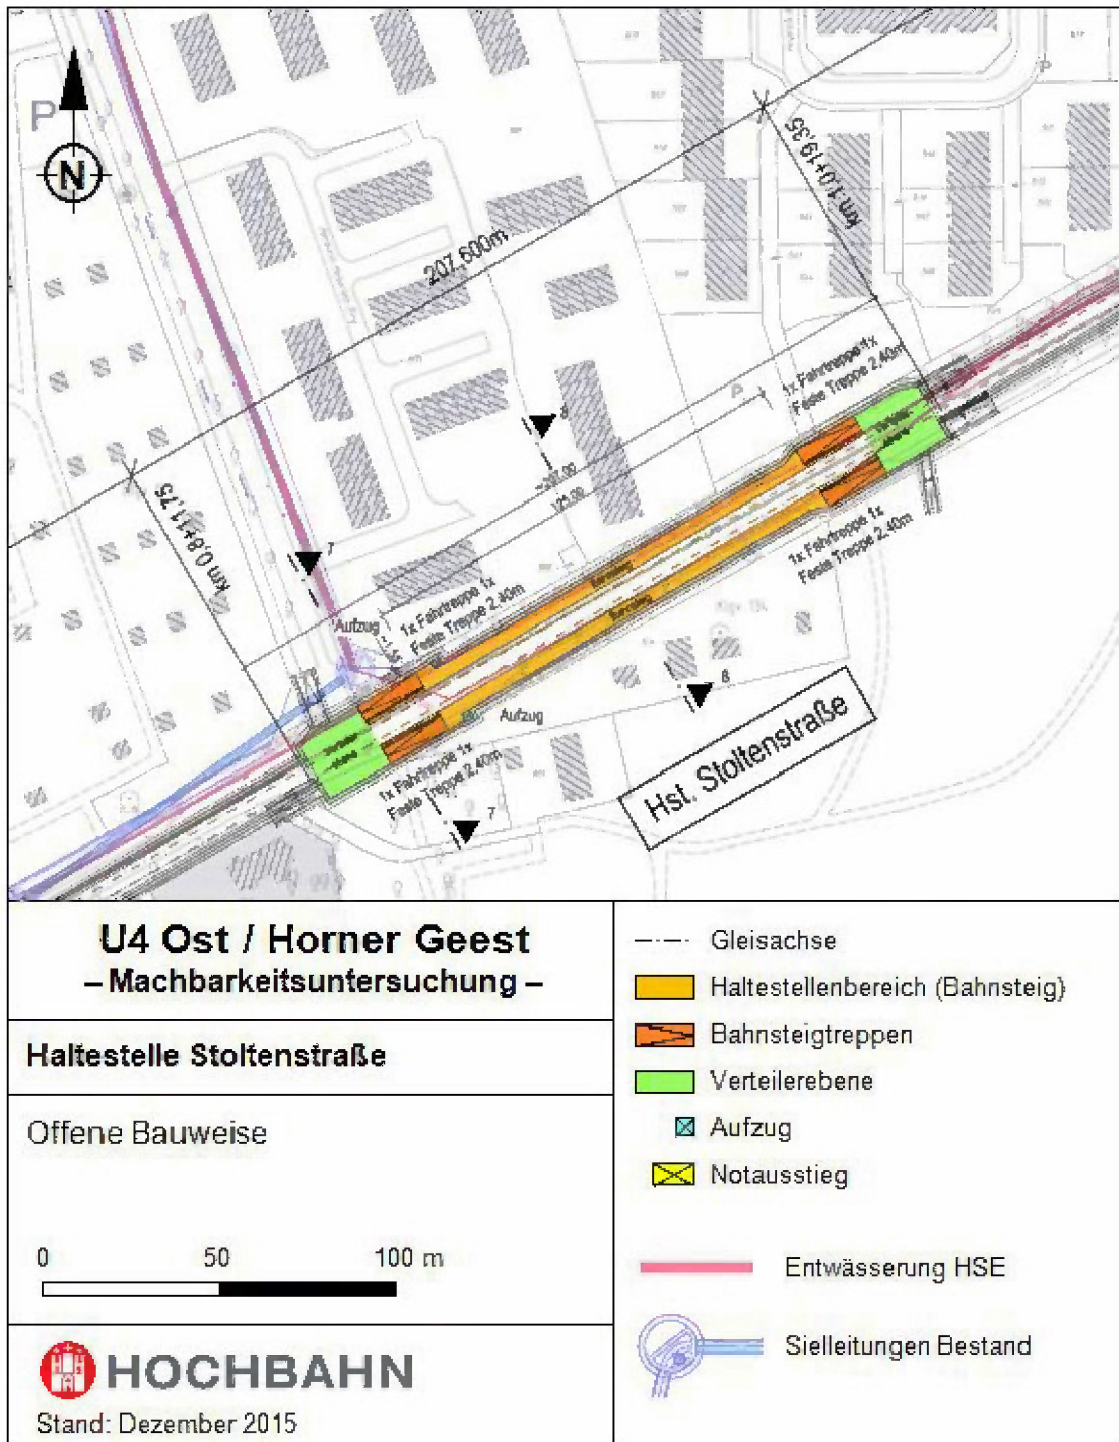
Lage der Haltestelle Stoltenstraße bei offener Bauweise
